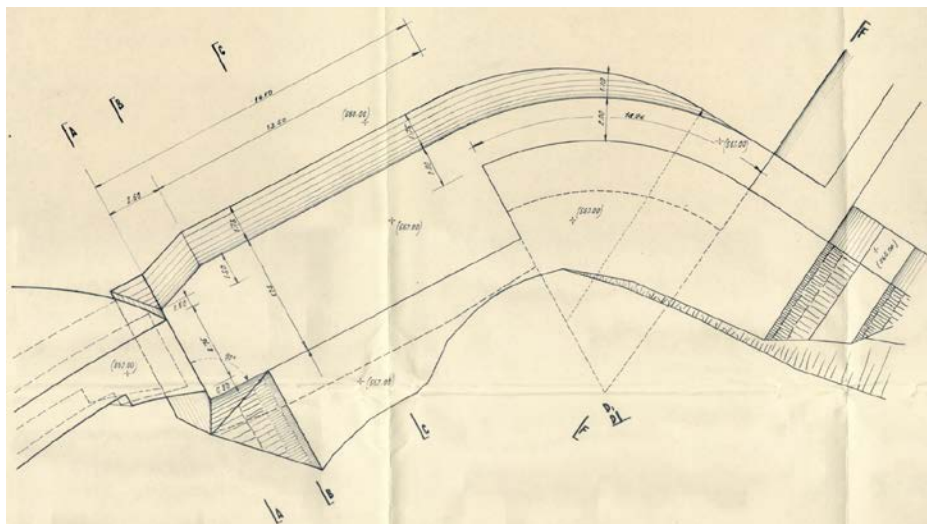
estratto dalla tavola n.24 allegata al collaudo – pianta della spalletta in sinistra orografica.
